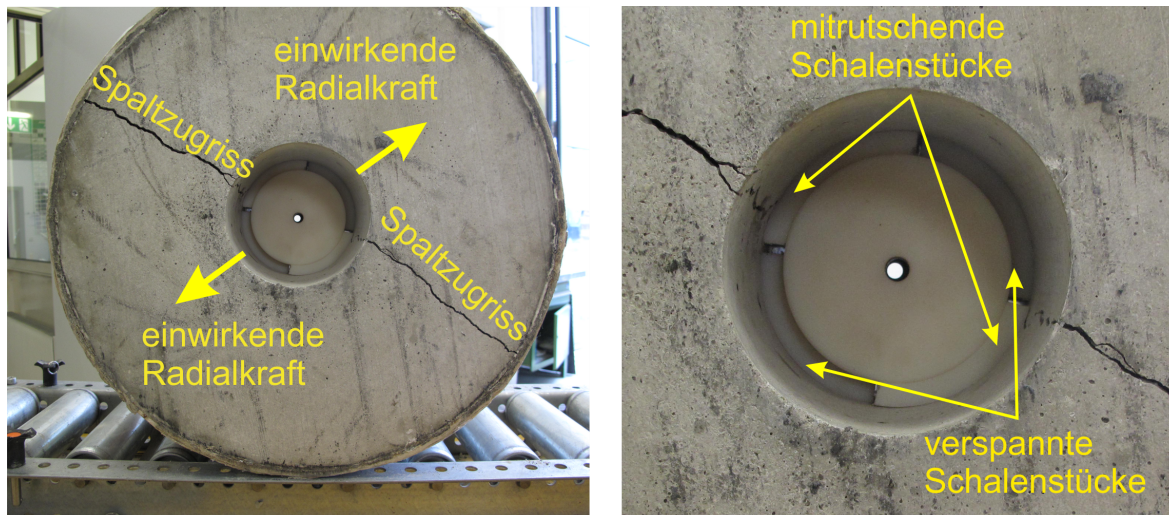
Spaltzugbruch des unbewehrten Betonkörpers aufgrund ungleichmäßiger Verspannung des Systems in der Betonöffnung
